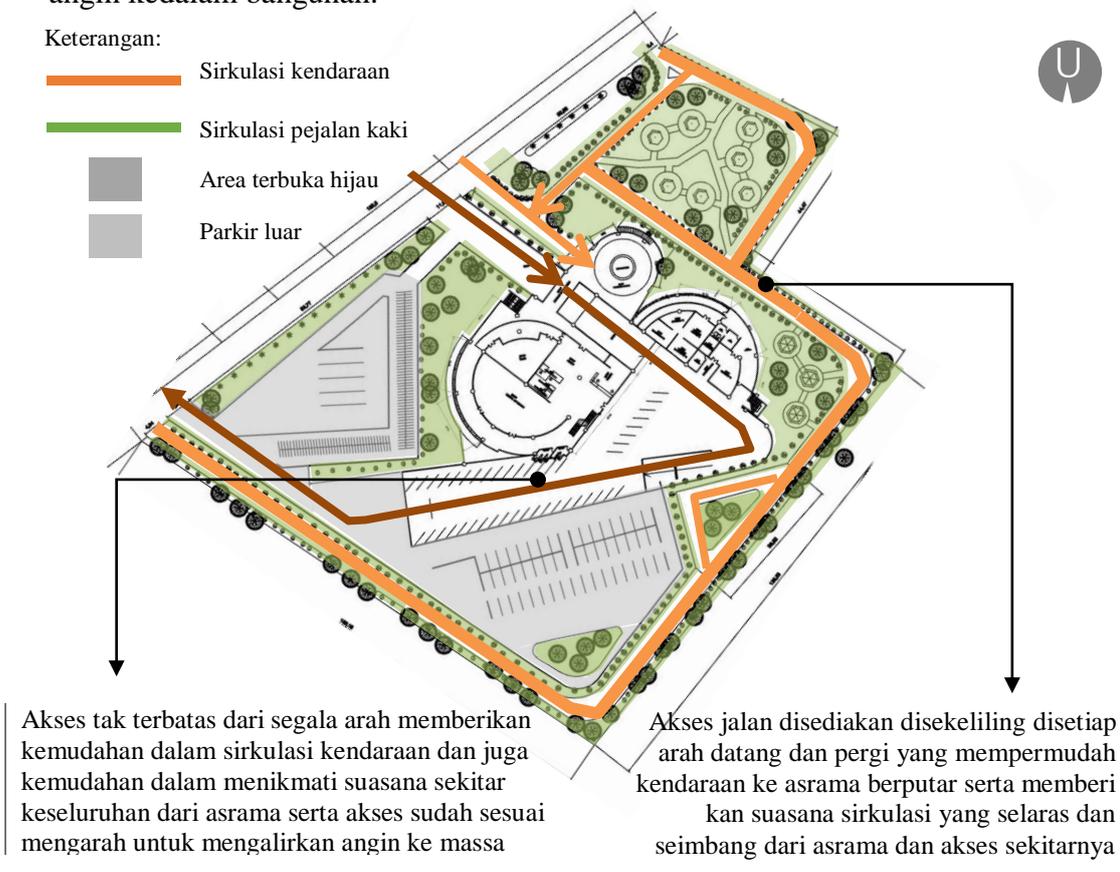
Layout plan integrasi ruang luar dan ruang dalam
